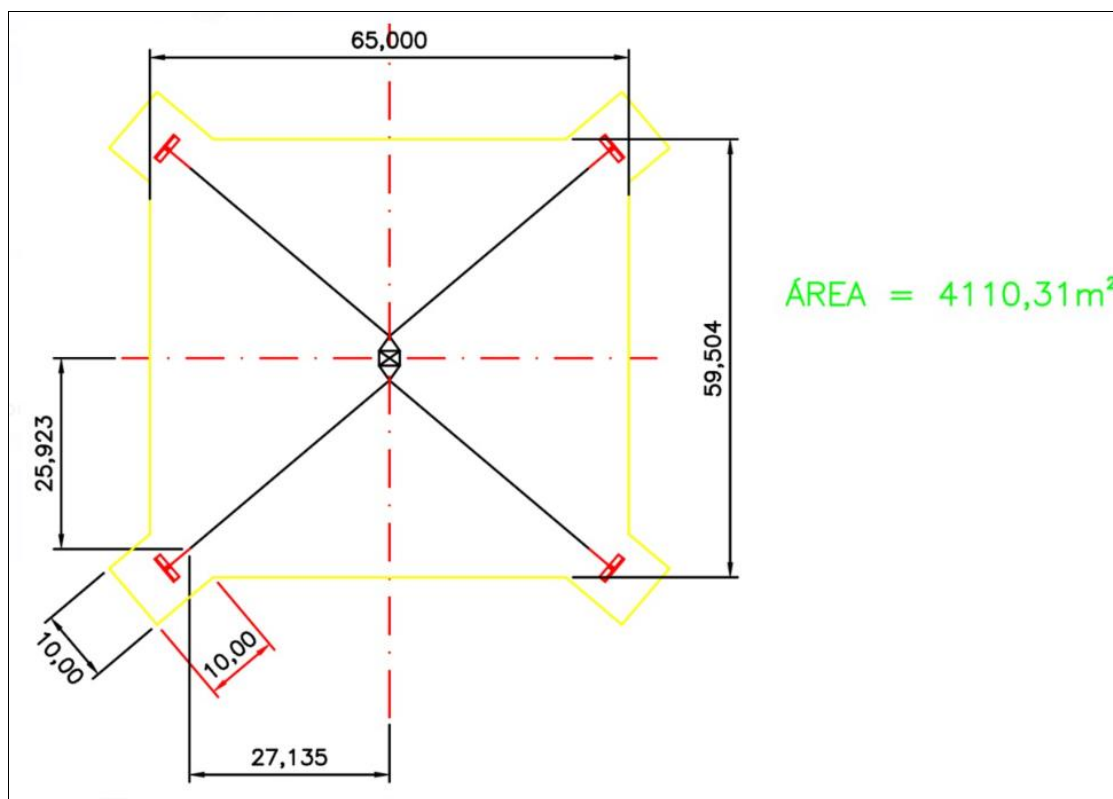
Croqui de supressão para implantação de torre estaiada.
